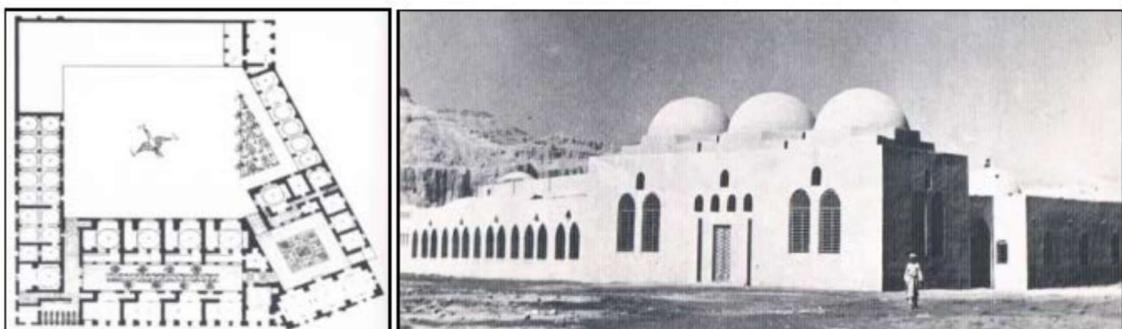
L'école des garçons, plan et façade. Source : FATHY Hassan. Op.cit., planches 93-94.
